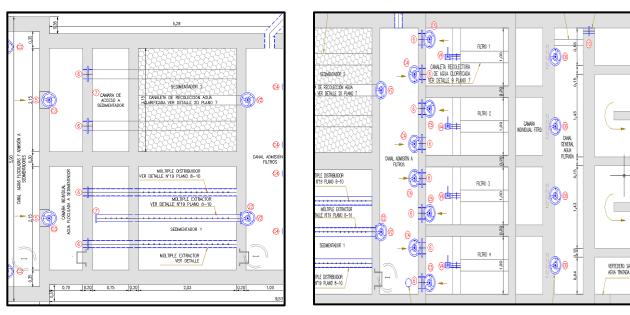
Sedimentadores, Sistema de Filtración, Válvulas y compuertas
